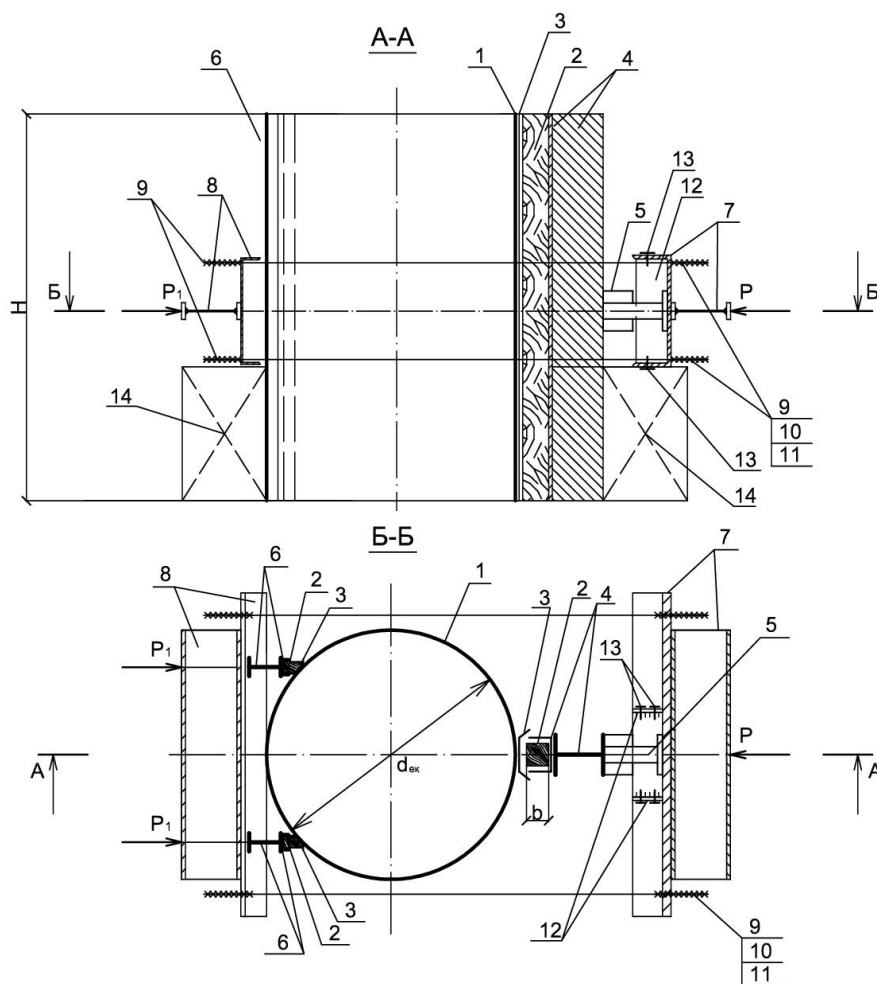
Установка для испытания нагружением цилиндрического стенового кольца:
